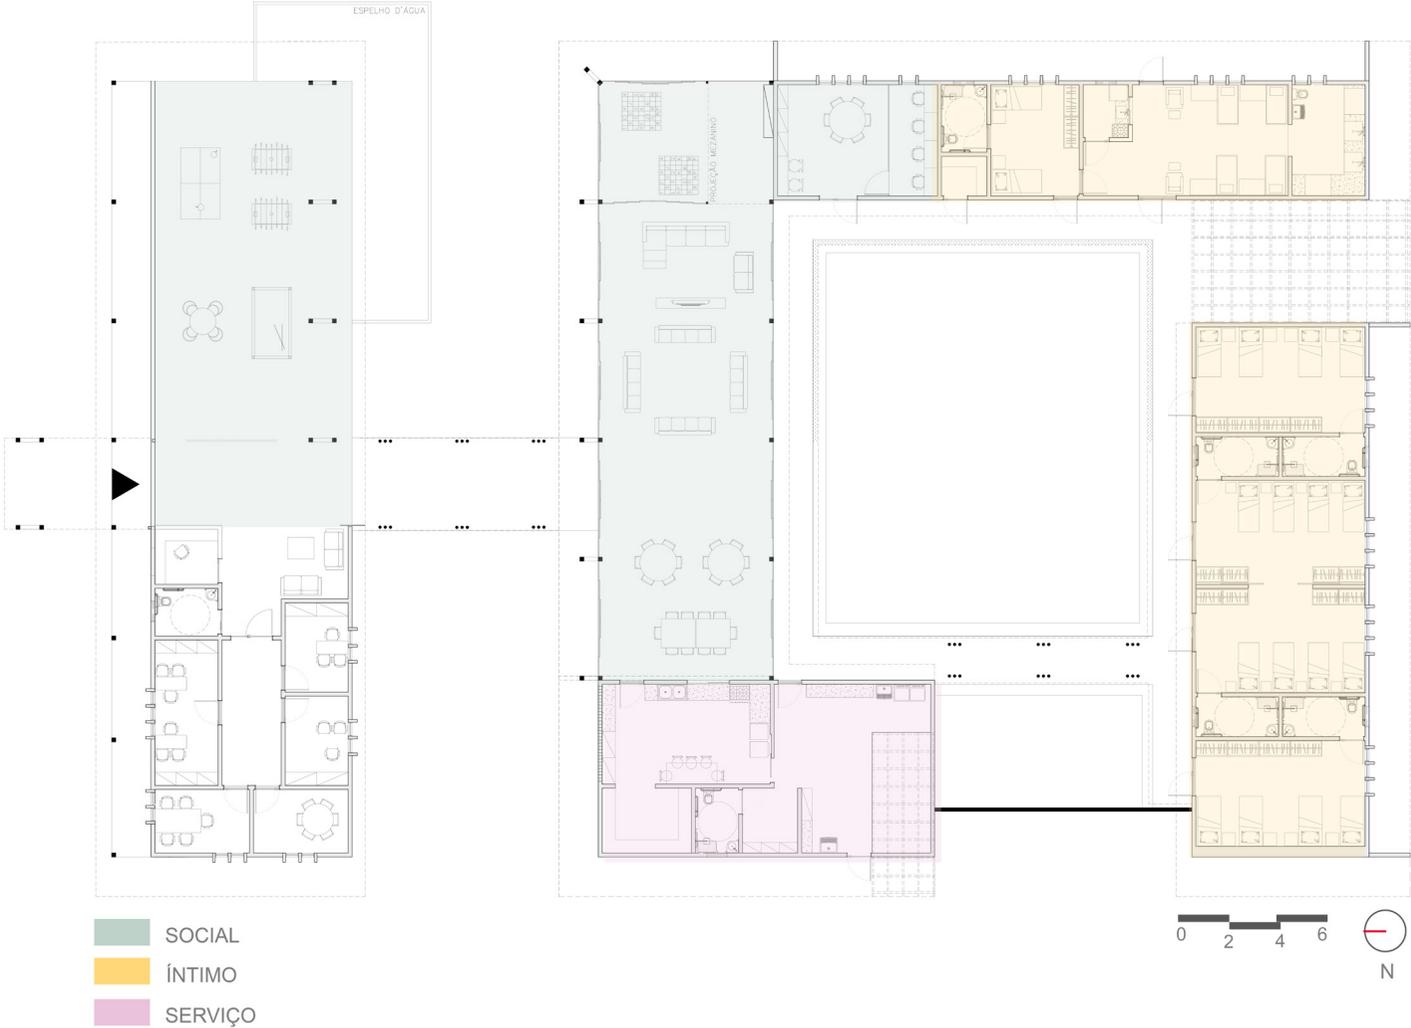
Planta Baixa Zoneamento Setor Íntimo
